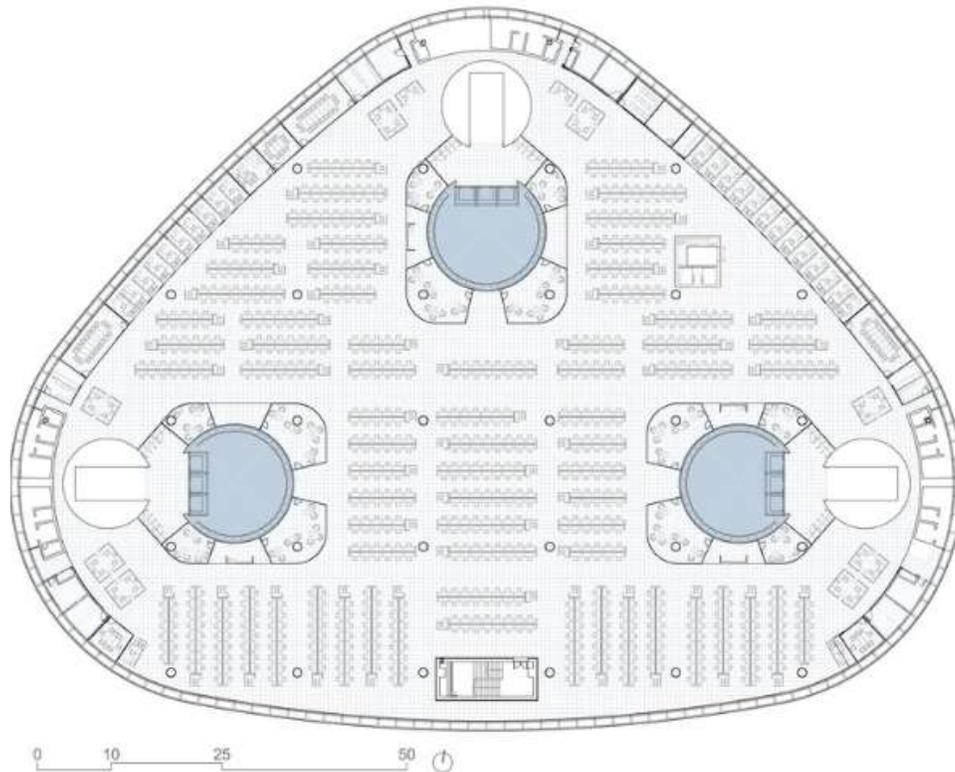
Call Center Querétaro Planta Arquitectónica
